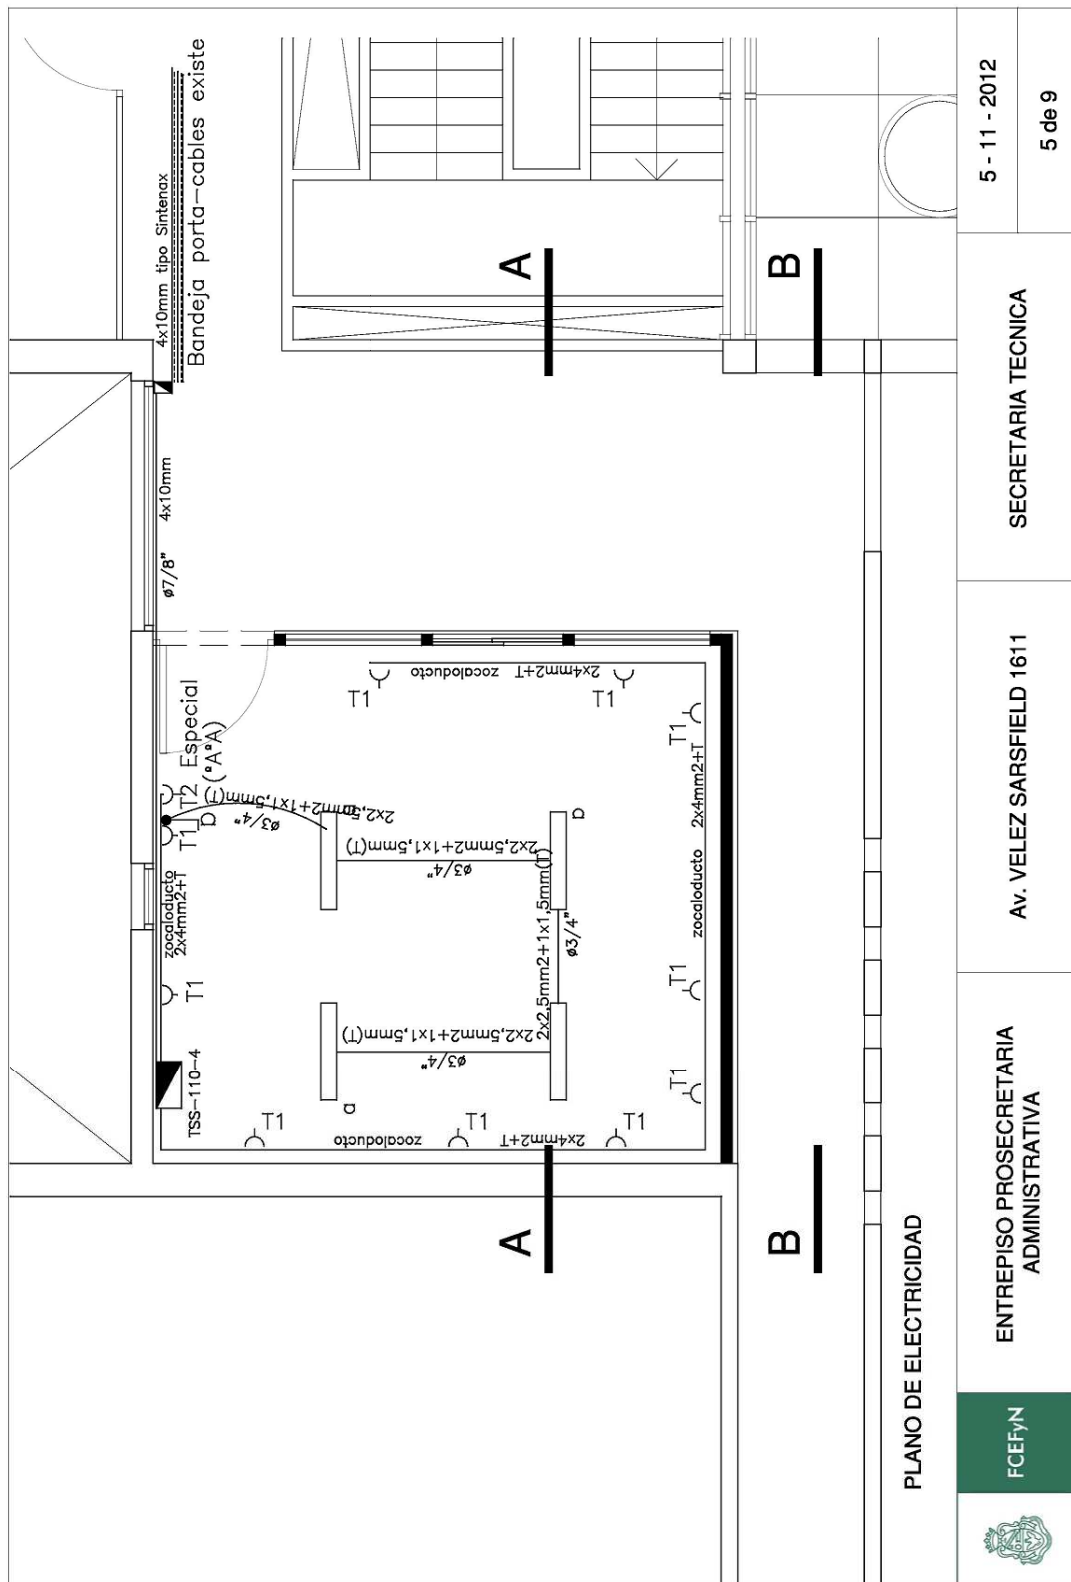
Plano 5 – Fuente: Digitalización de planos originales
